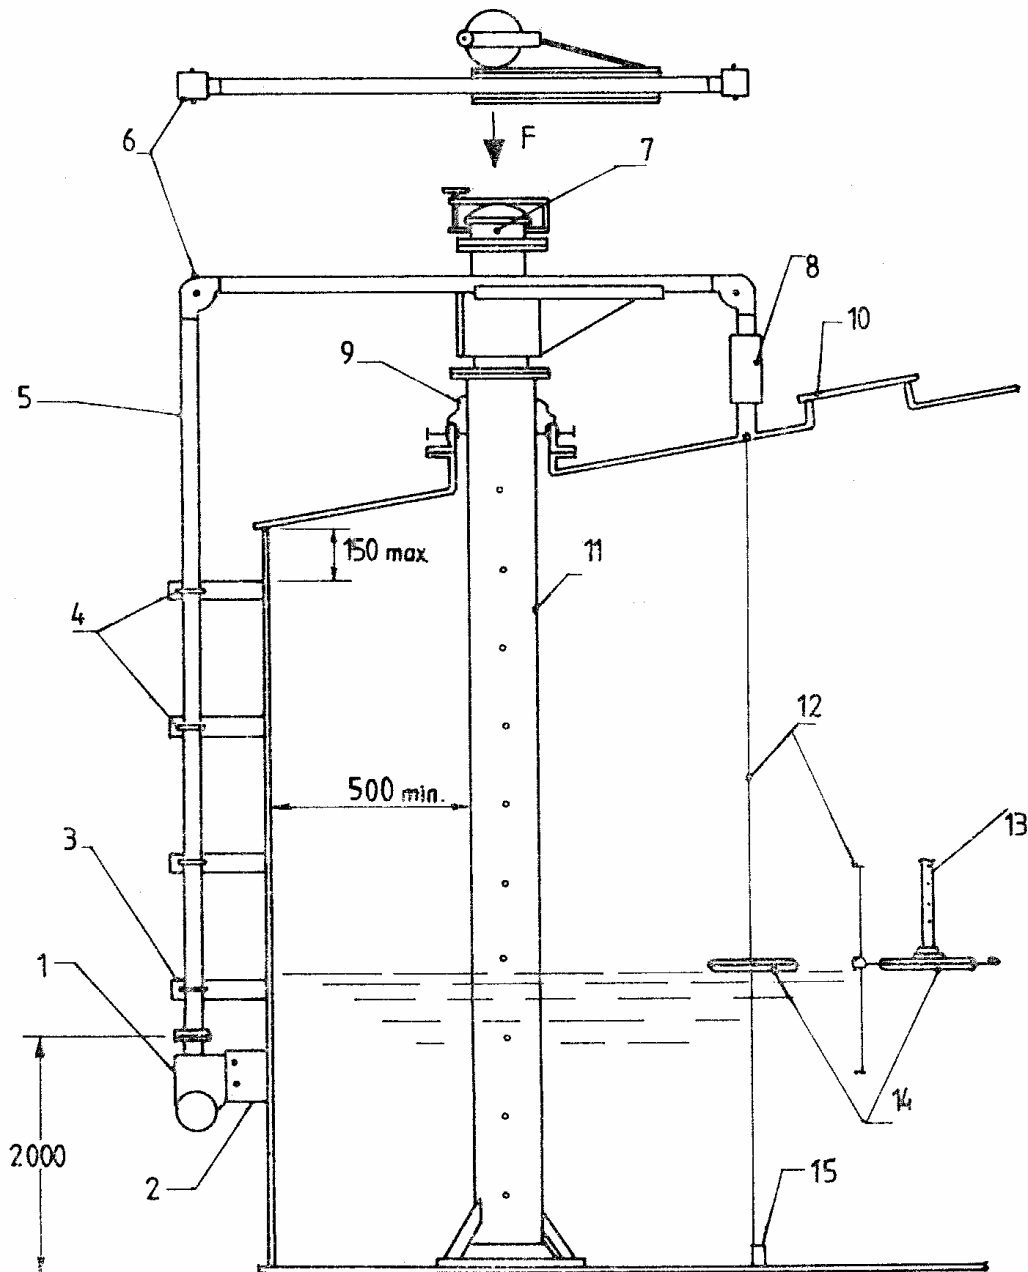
Principe de montage d'un tube de guidage et d'un jaugeur sur un réservoir cylindrique vertical à toit fixe, dont le gonflement sous charge doit être pris en considération, le fond du réservoir étant stable
